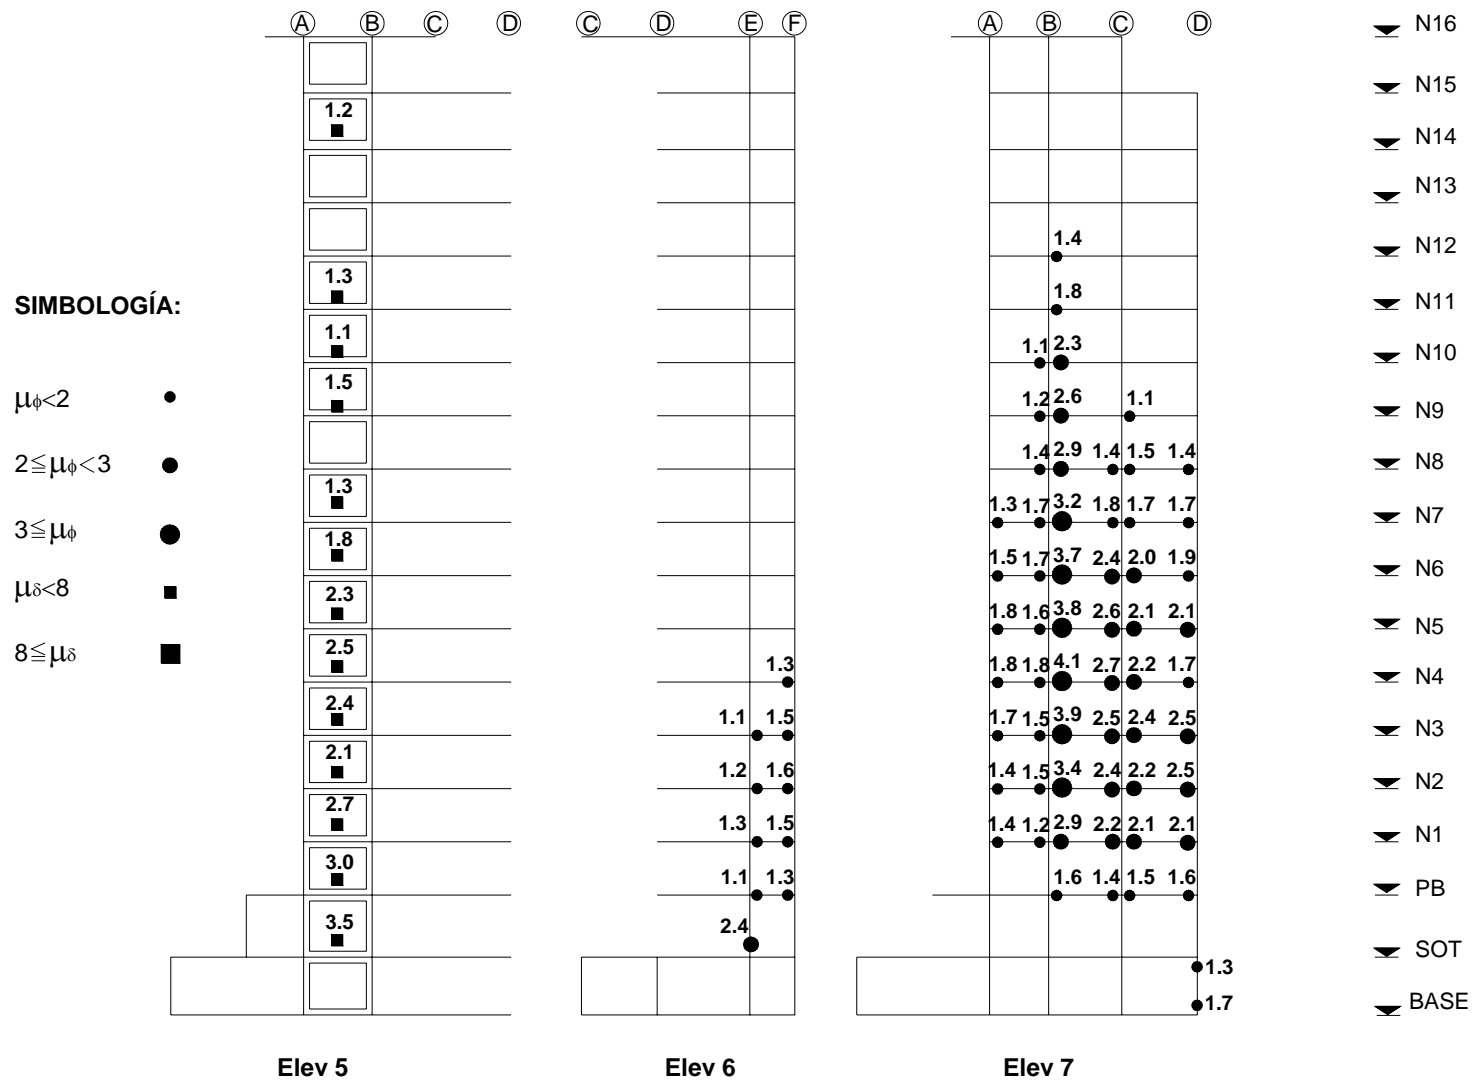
Ductilidades locales máximas de vigas, columnas y muros de concreto reforzado, en las elevaciones 5, 6 y 7, para la SIM81
